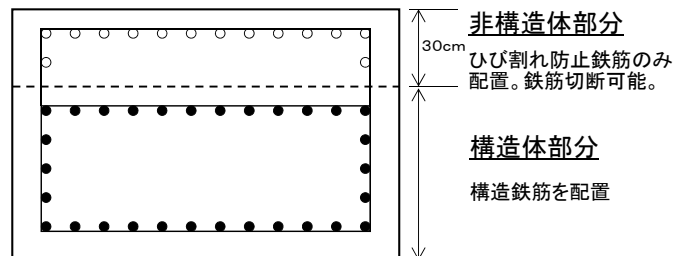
アンカー等の追加・変更対応を考慮した基礎スラブ構造(断面図)
